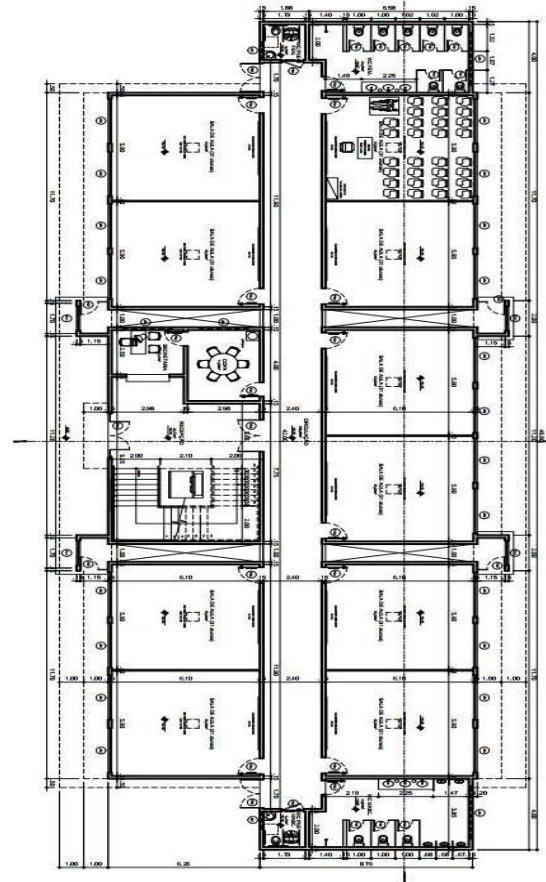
Planta Baixa Pav. Térreo - Fonte:
